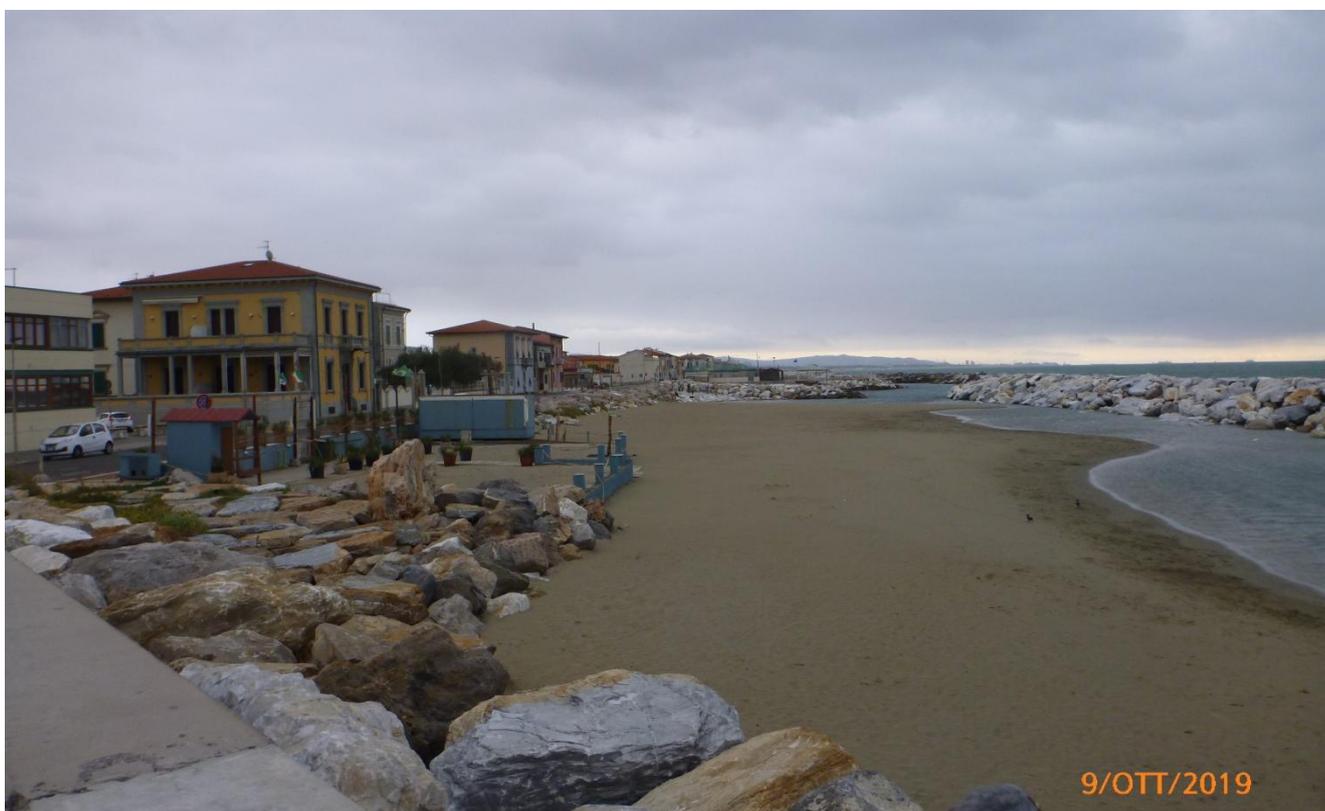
Foto 22: Foto da imboccatura Porto di Livorno – vista verso Sud
